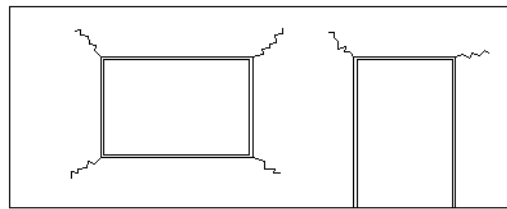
Fissuras nos cantos das aberturas devidos atuações da sobrecarga.
